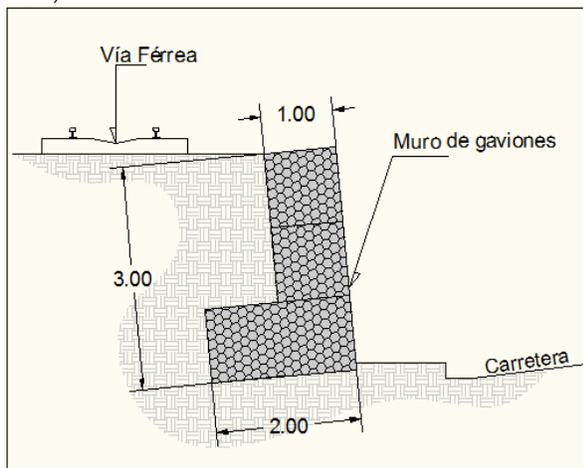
Detalle de obra complementaria #21, (Fuente: Autor)
